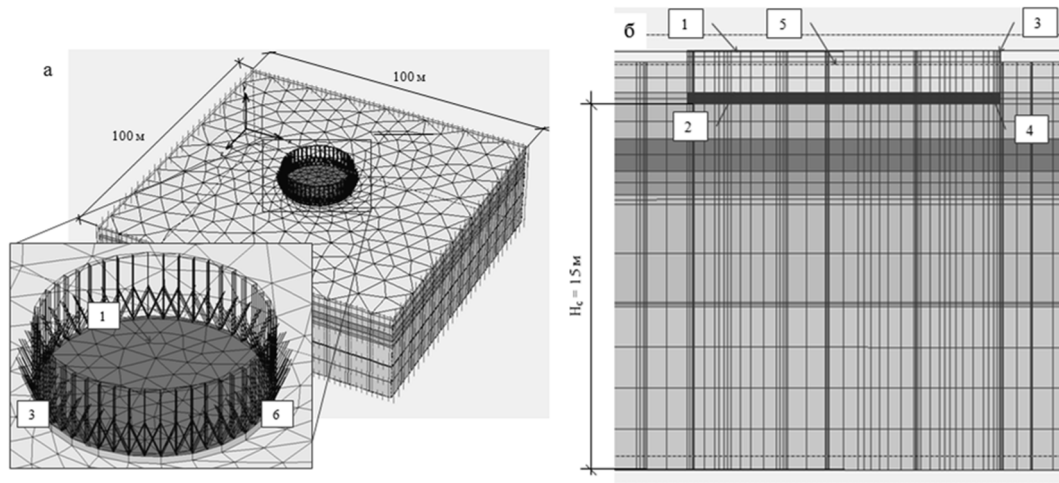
Розрахункова схема для моделювання НДС окремого силосу СМВУ 220.16.В12: а – загальний вигляд моделі та сітки скінченних елементів; б – вигляд розрахункової схеми у розрізі; 1 – верхня залізобетонна плита; 2 – нижня залізобетонна плита (дно силосу); 3 – стінка плитного фундаменту; 4 – щебенева подушка; 5 – ущільнений пісок; 6 – навантаження від ваги стін силосу та надсилосних конструкцій; H_c – глибина товщі ґрунтів, яка стискається
